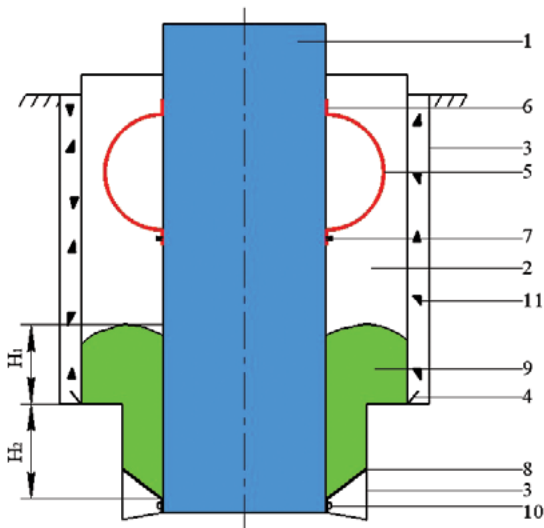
Принципиальная схема оборудования устьев скважин: 1 — полимерная эксплуатационная колонна; 2 — кондуктор; 3 — стенки скважины; 4 — башмак кондуктора; 5 — подпружиненный центратор; 6 — подвижная опора центратора; 7 — неподвижная опора центратора; 8 — эластичная упругая манжета; 9 — вязкоупругий материал; 10 — хомут; 11 — буровой шлам. H_1 — высота вязкоупругого материала в кондукторе; H_2 — высота вязкоупругого материала под башмаком кондуктора
